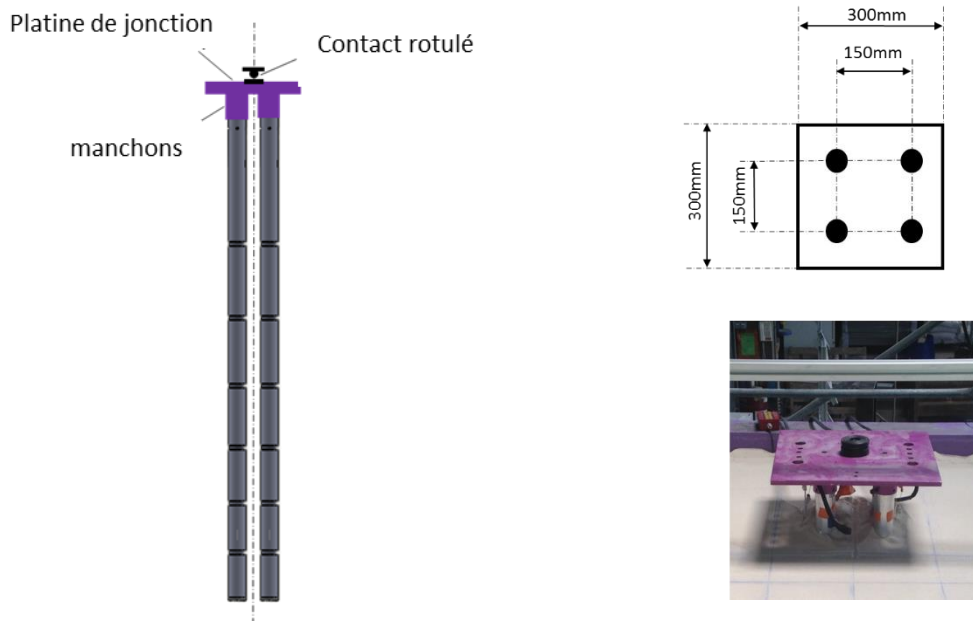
Schéma du montage du groupe de (2x2) pieux
